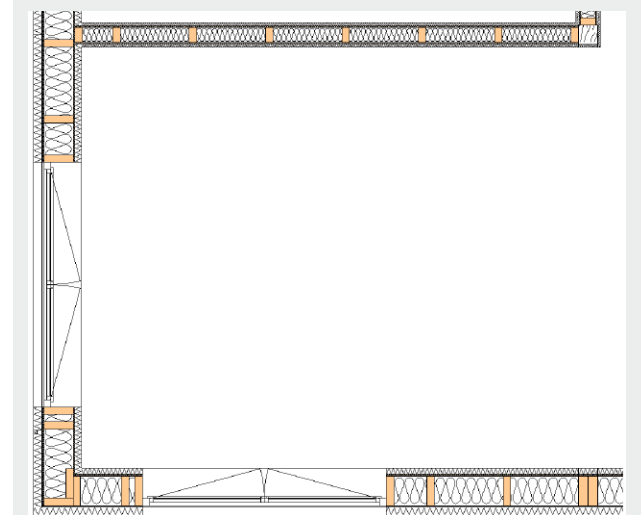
Draufsicht mit vertikaler Begrenzung ohne Holzbalken
